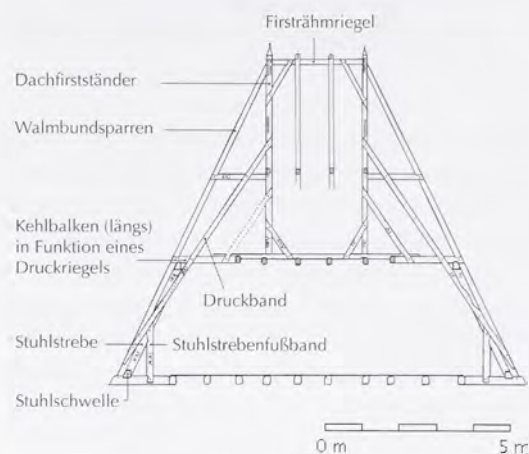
Sparrendach, Längsschnitt. Durch zwei Kehlbalcken (grau) verstärkte Sparrenpaare werden in der Firstachse durch einen Längsbund unterstützt. Er ist über die gesamte Dachhöhe als abgesprengter Längsbund abgebunden. Im 2. Dachgeschoss erfolgt die Absprengung u. a. über lange Druckbänder, die von den Dachfirstständern über die Stuhlstreben im 1. Dachgeschoss bis zum Dachfuß reichen. Basel, Martinsgasse 12, 1424 (d).
